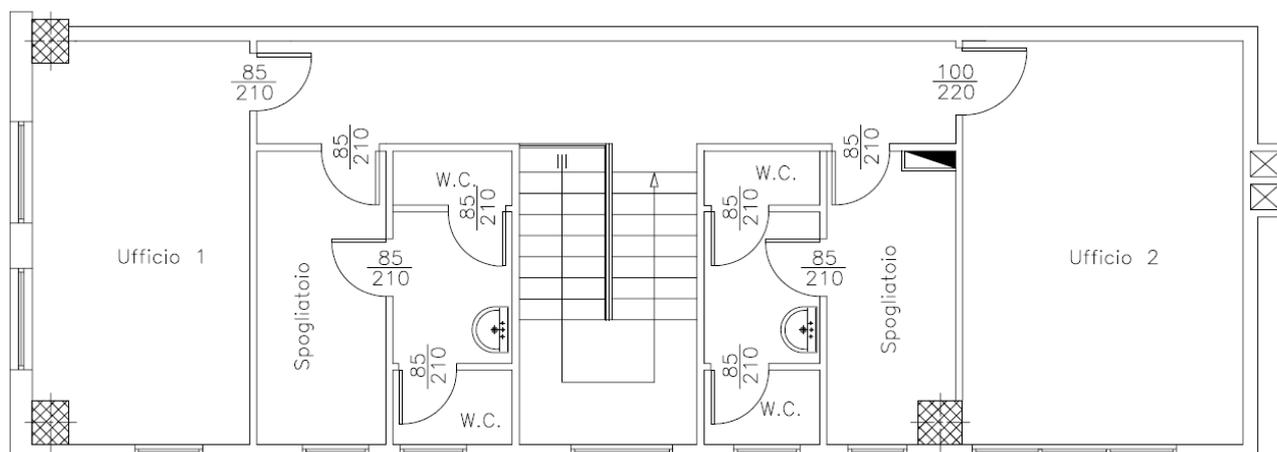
Pianta primo piano dell'edificio adibito ad uffici a Roccavione.
